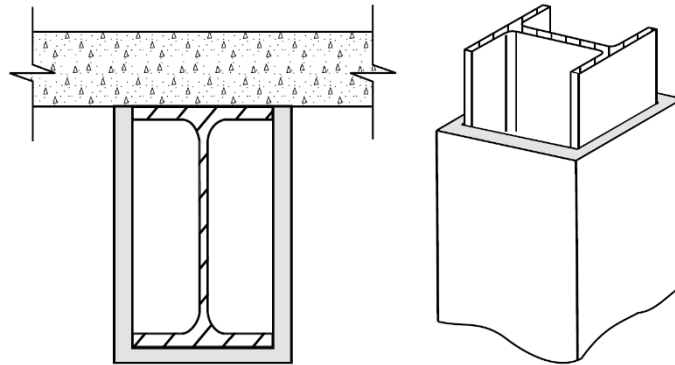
Viga e coluna metálicas protegidas com placas [5]
